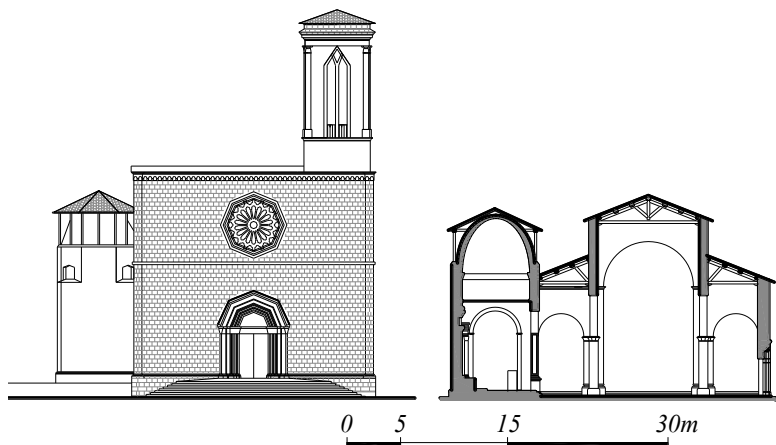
Chiesa di S. Silvestro: Prospetto facciata e sezione trasversale sulla navata
